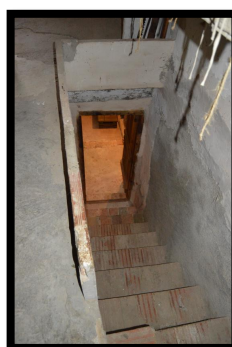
Nova escala d'accés a la primera planta. (Font: Autor.)
